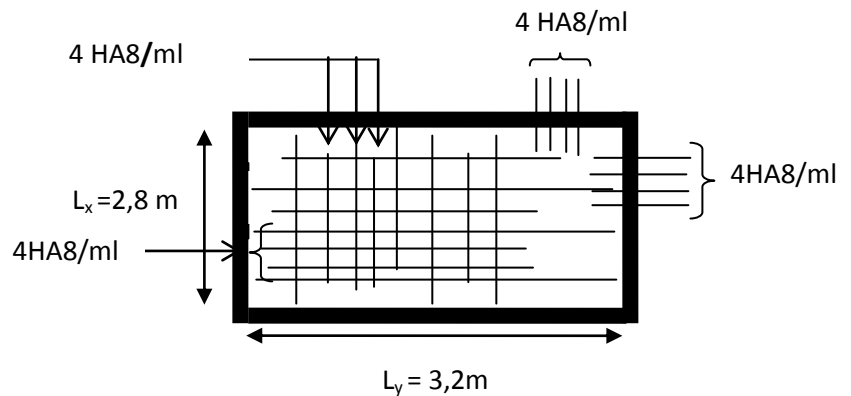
Schéma de ferrailage de la dalle pleine incliné de comble.
